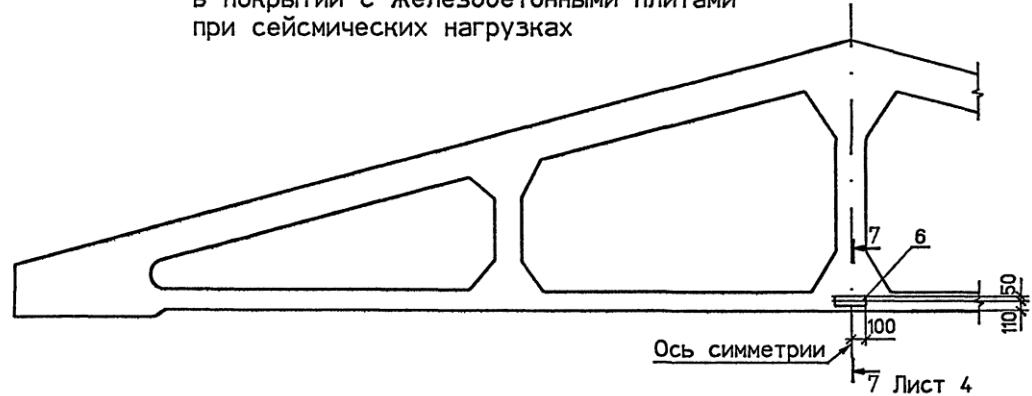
Для крепления связей к средним фермам в покрытии с железобетонными плитами при сейсмических нагрузках
